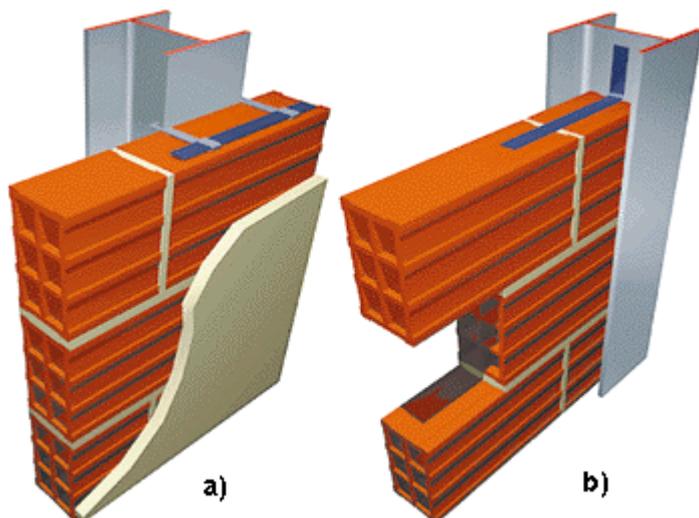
a, b - Collegamento di una parete in elementi forati di laterizio a un profilato in acciaio mediante staffe poste nei giunti orizzontali: a) parete inserita. b) parete passante.
